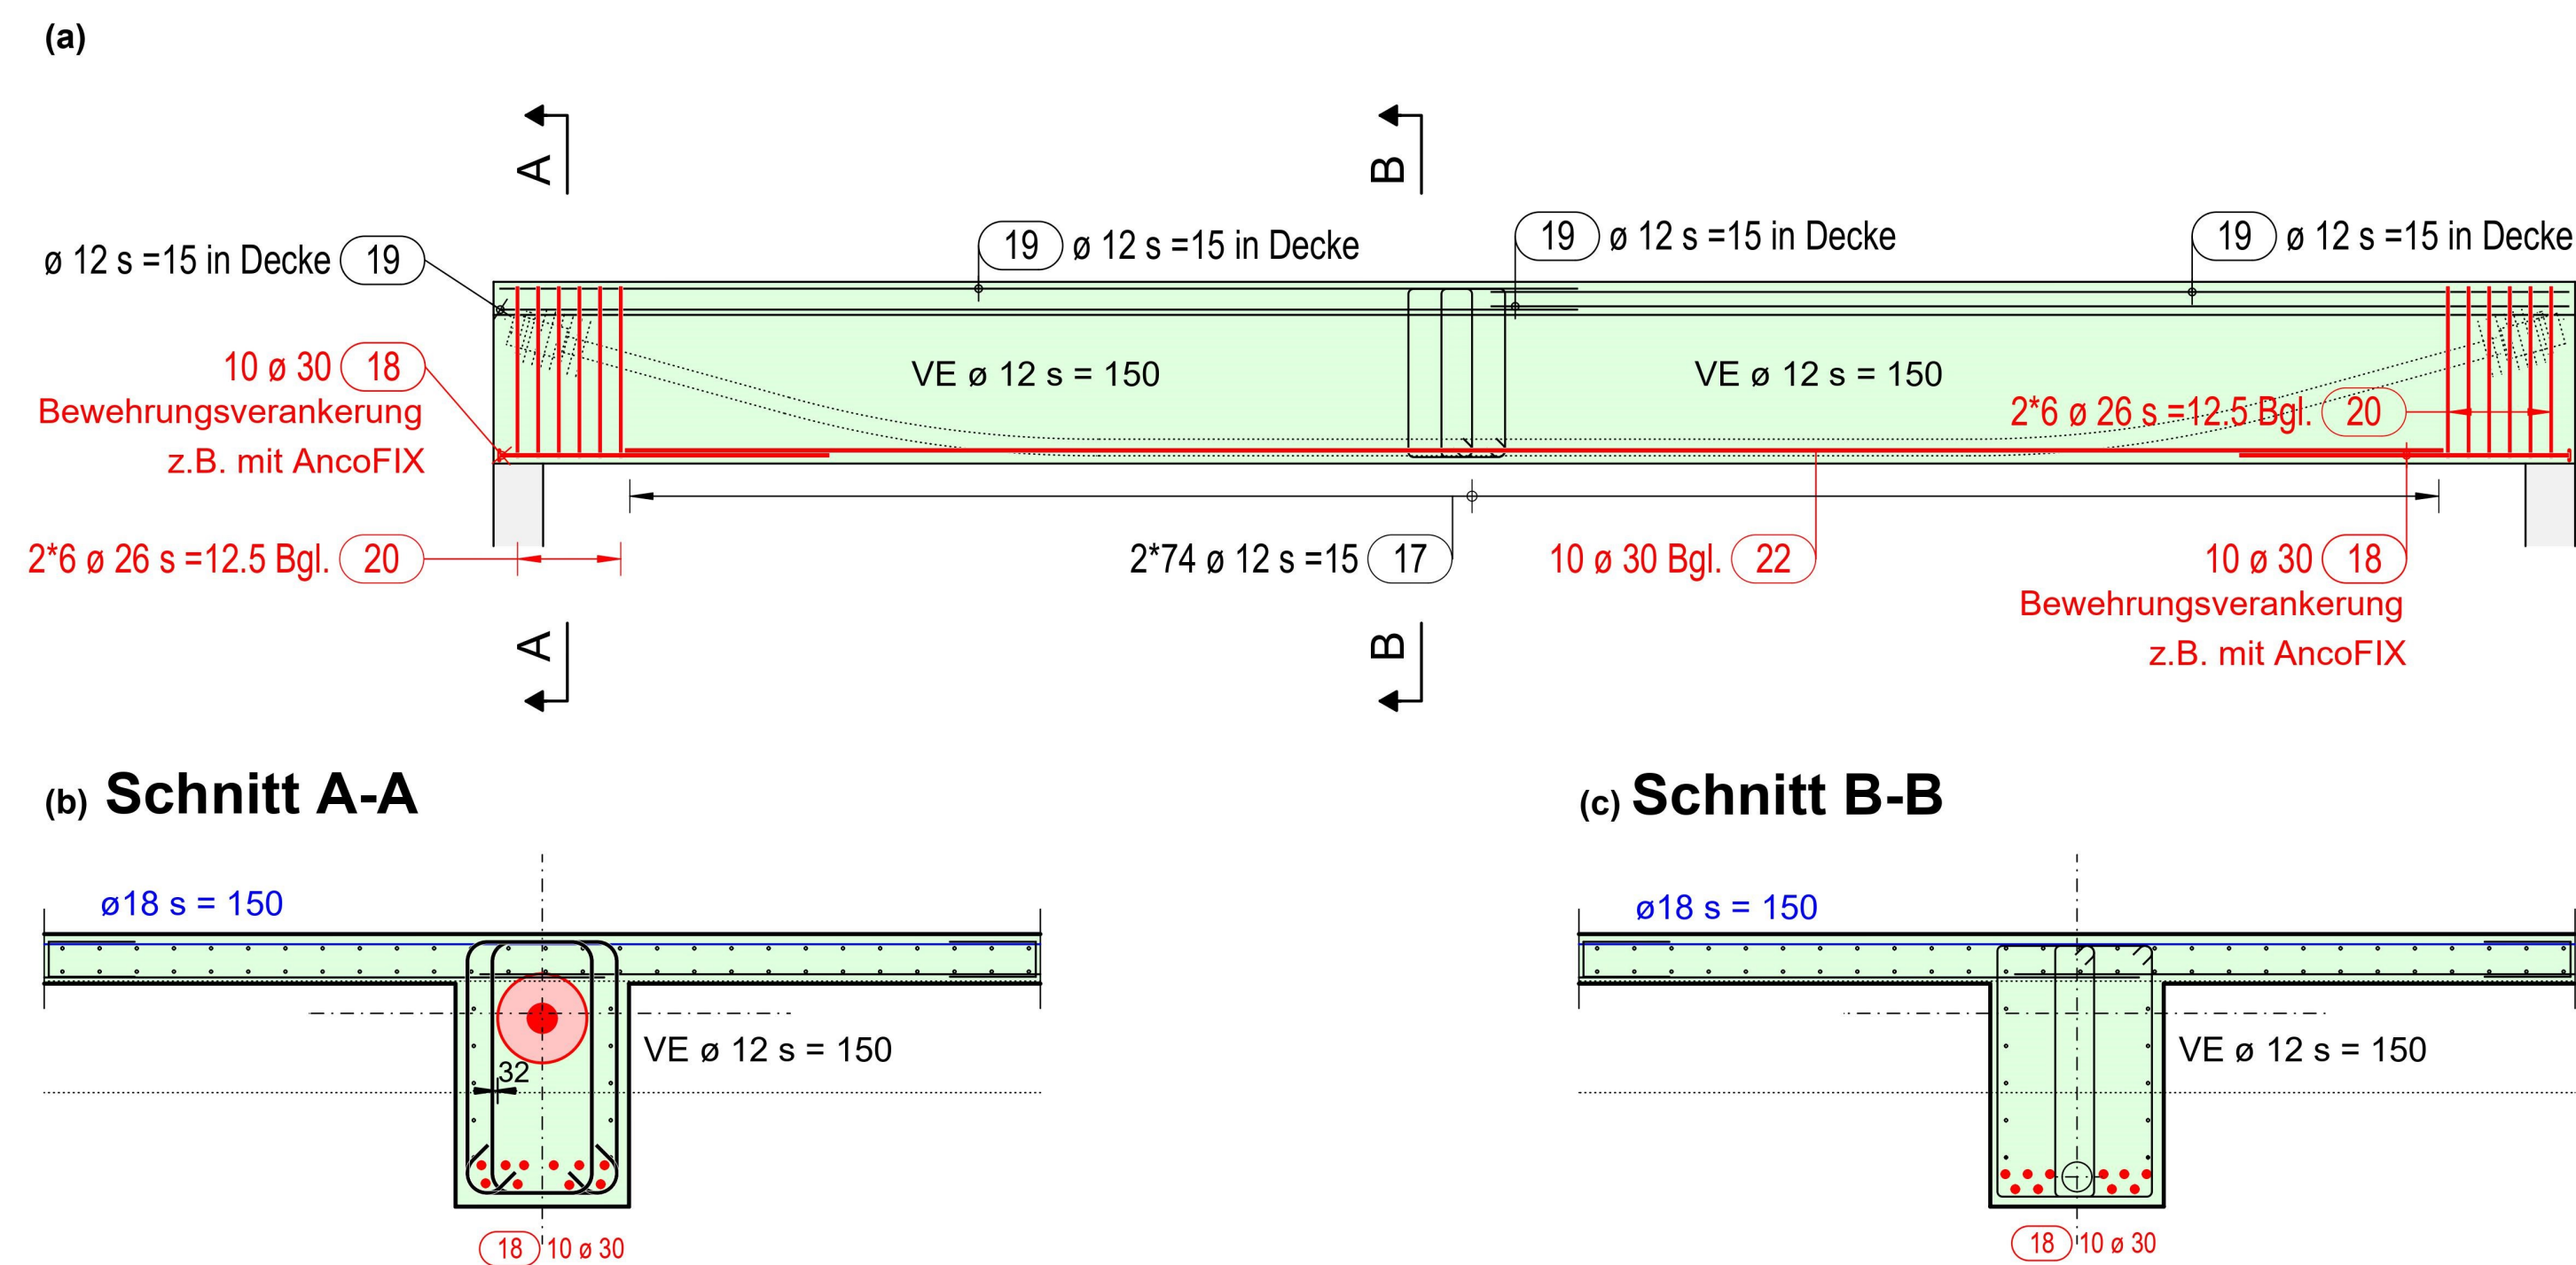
(a) Bewehrung Abfangträger in der Ansicht (b) Schnitt A-A durch den Auflagerbereich mit der Krafteinleitung des Vorspannkabel rot dargestellt (c) Schnitt B-B Durch die Trägermitte mit der benötigten statischen Bewehrung (Eigene Darstellung)
